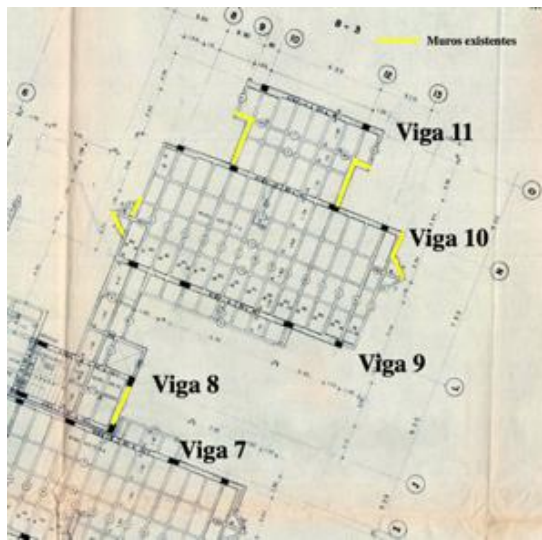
Tercera Placa - Plano estructural TB 2, Bloque 3.
